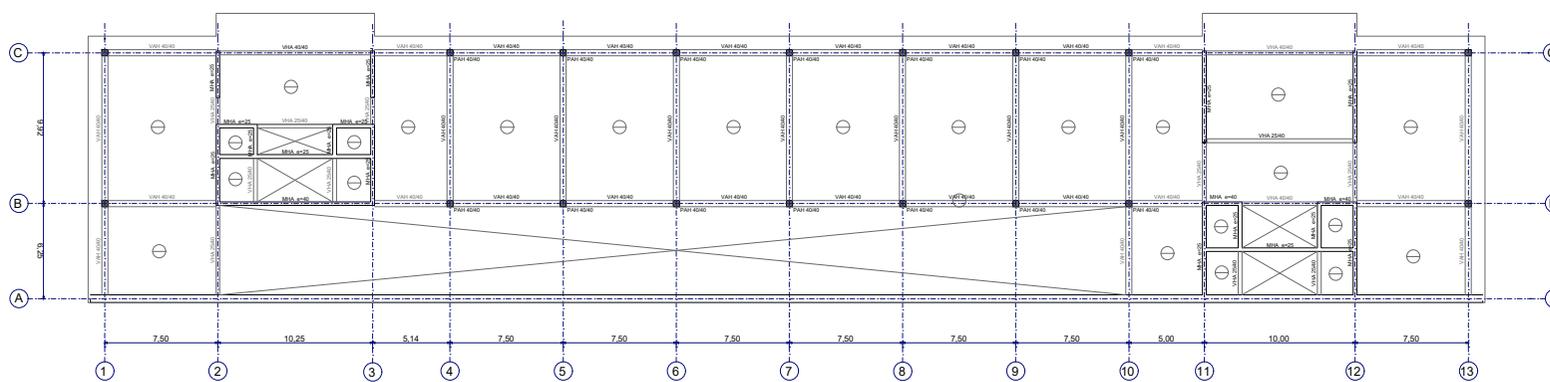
Planta estructural piso tipo. Fuente: Elaboración propia
